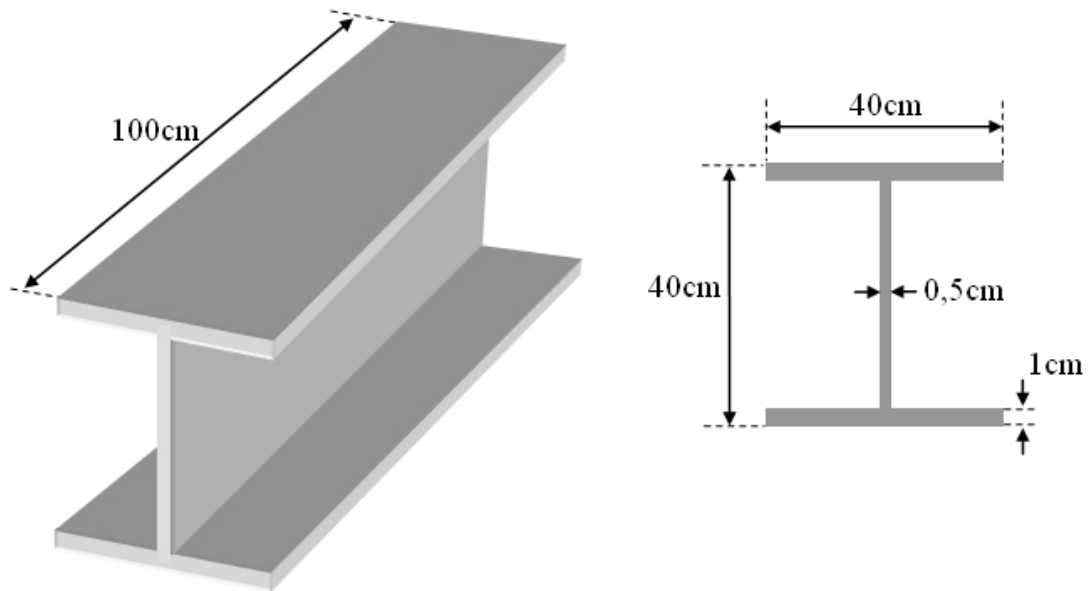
Dimensões geométricas da barra de seção transversal I
